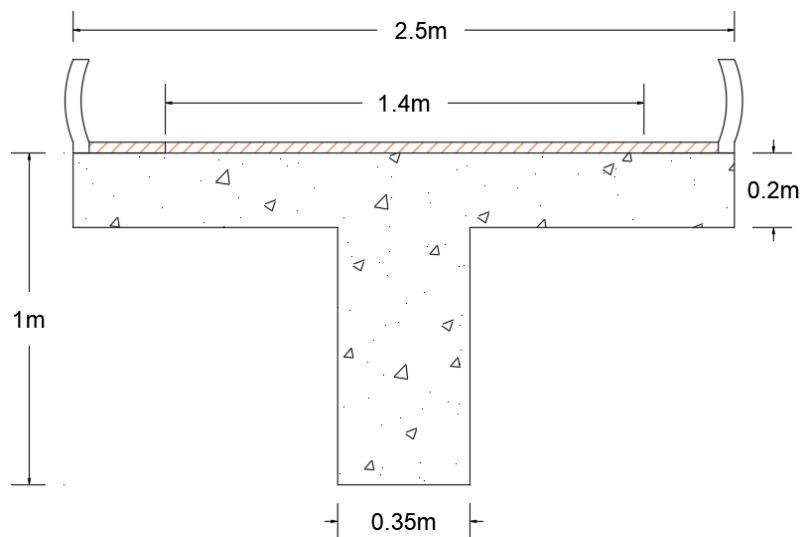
Dimensiones sección transversal puente tipo viga T.
